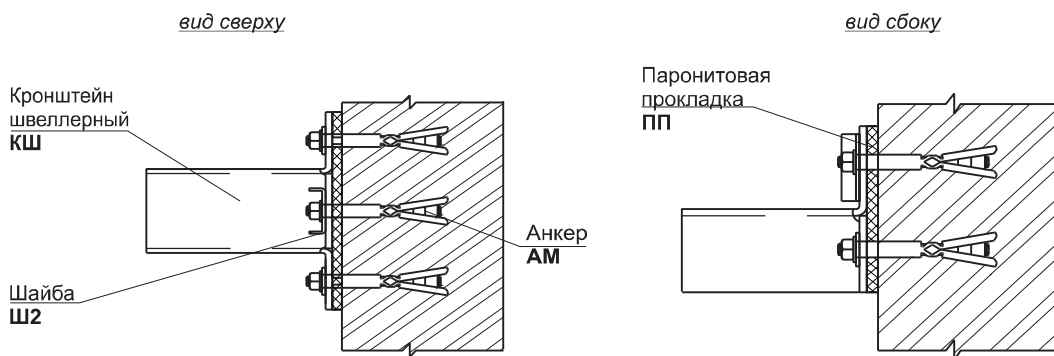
Узел крепления кронштейна КШ к стене тремя анкерами.
